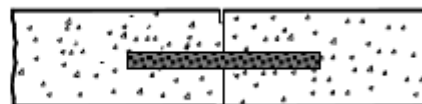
Junta transversal de construcción con pasadores. (Fuente: Instituto del Cemento Portland Argentino).
